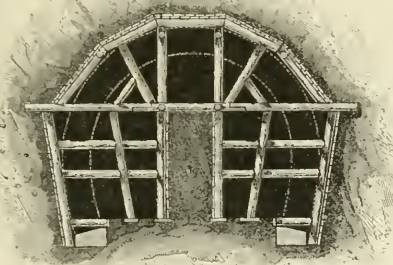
Bau des Kerschbacher Tunnels [südl. Staatsbahn].
